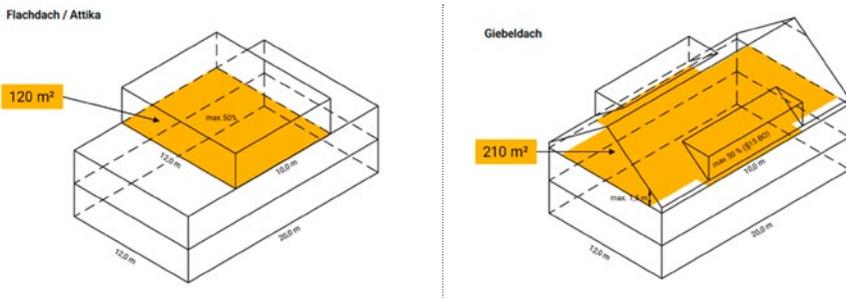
Erläuterungsskizze neue Messweise Attikageschoss und Dachgeschoss (orange = neu anzurechnende Flächen)
